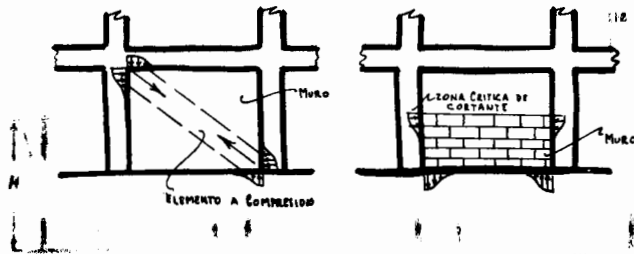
Acciones de los muros sobre la estructura.
